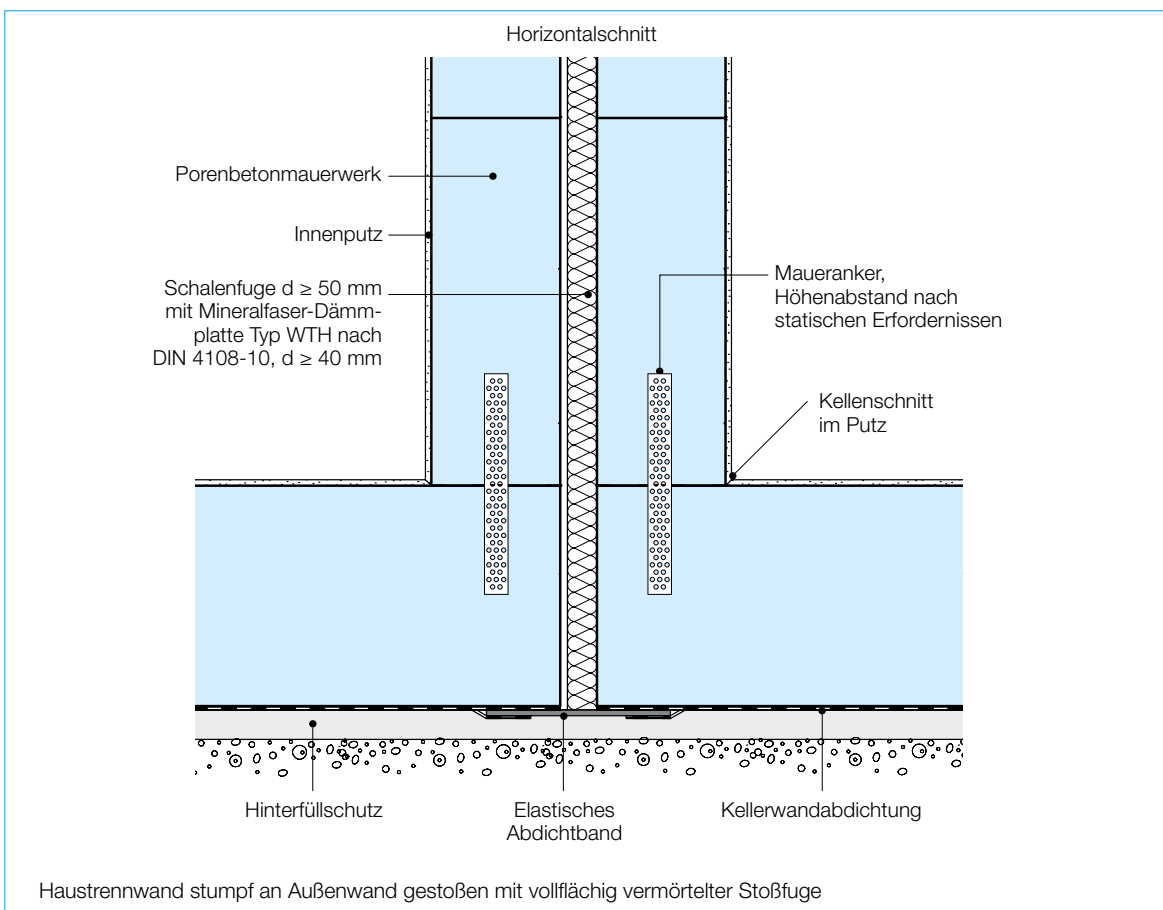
Seitlicher Anschluss einer zweischaligen Haustrennwand aus Porenbetonmauerwerk an eine Außenwand im Kellergeschoss (vertikale Abdichtung)
